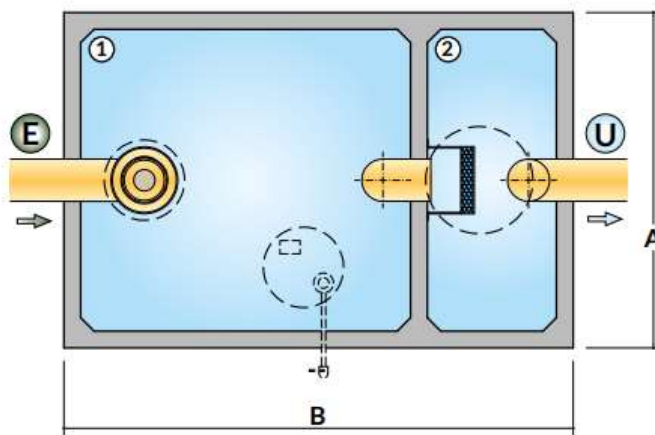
Estratto dalla planimetria di progetto delle reti meteoriche
